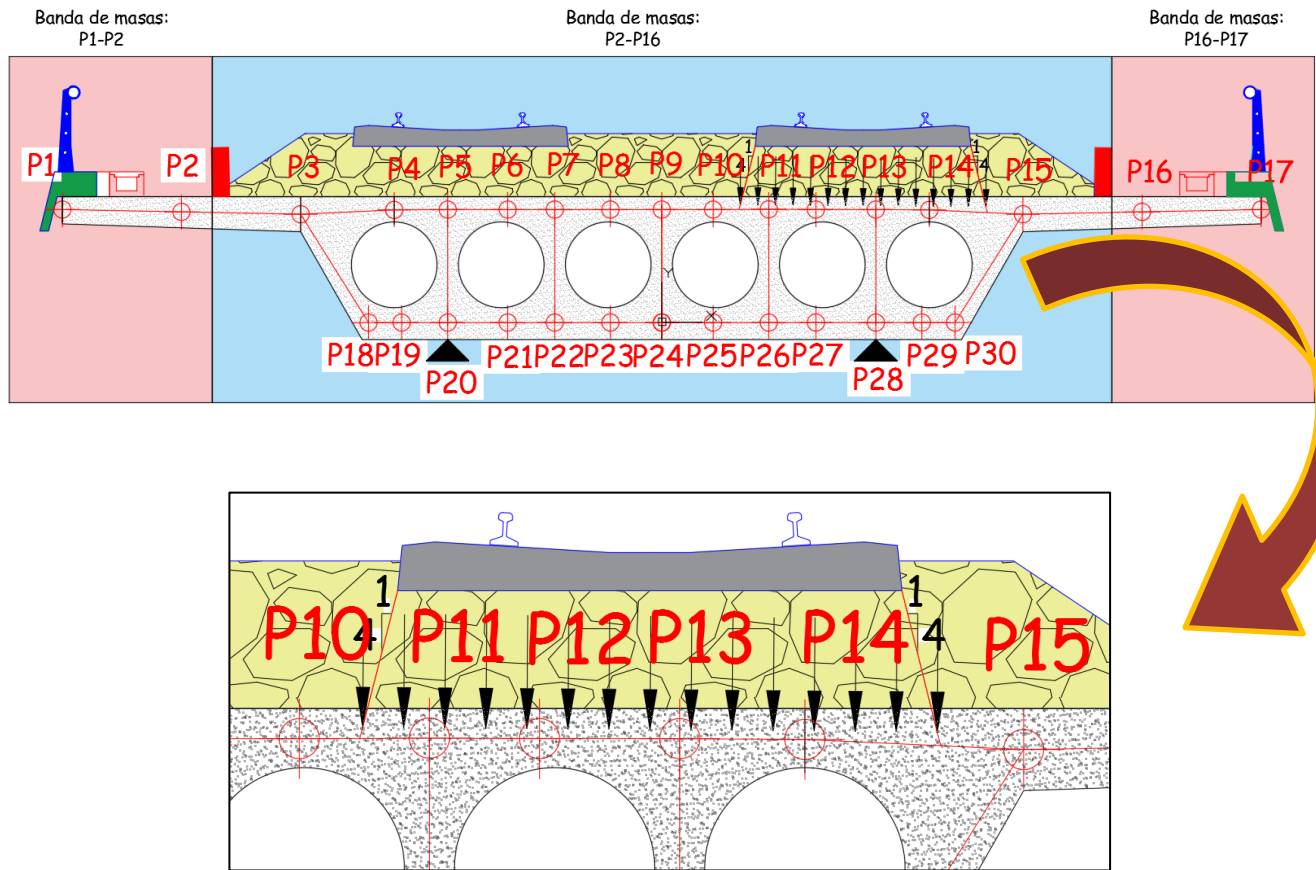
Divisiones en bandas de masas en tablero y puntos de aplicación. Ejemplo tablero 20 metros.
